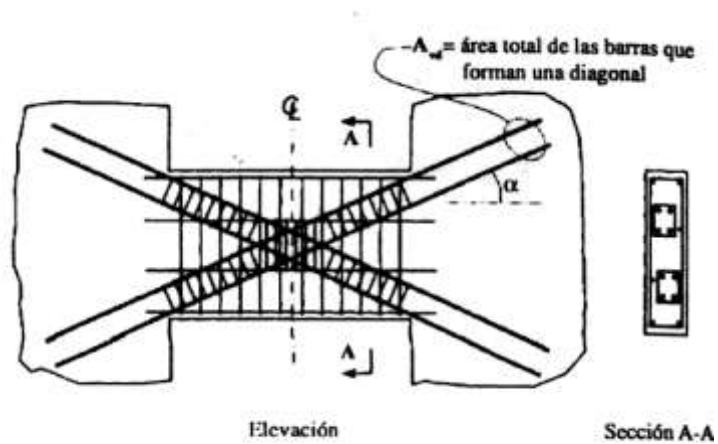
Viga de acoplamiento con armadura orientada diagonalmente.
